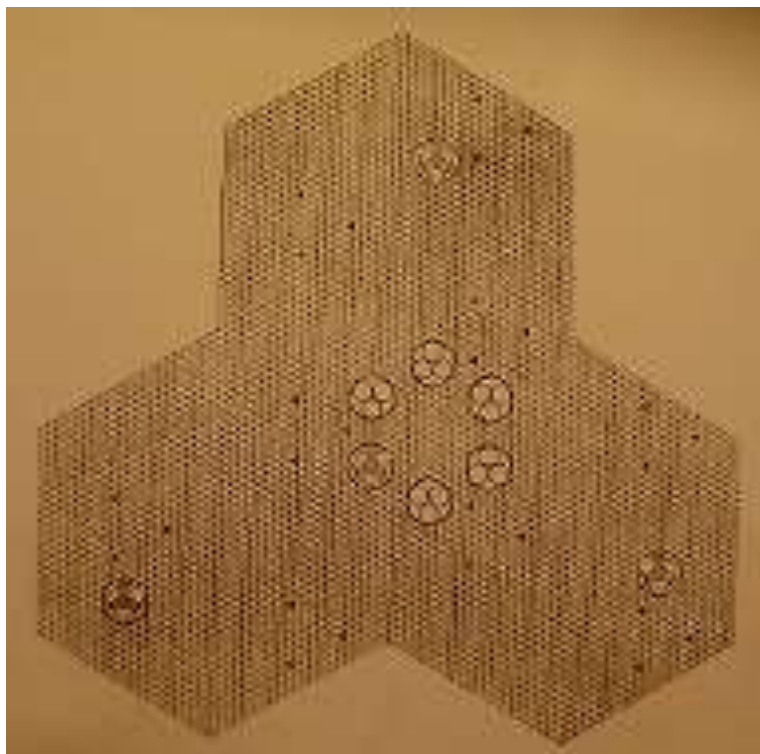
Detalle sección en planta de la segunda versión de la City Hall Tower.
